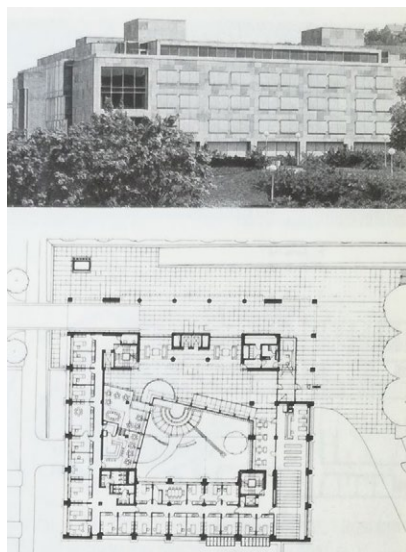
Planta y fachada hacia la avenida del congreso.
